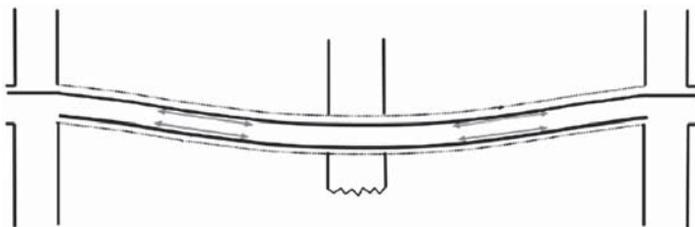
Работа конструкций перекрытия в условиях предельного состояния при возможном возникновении мембранного эффекта с армированием нижней и верхней зоны балки или плиты
